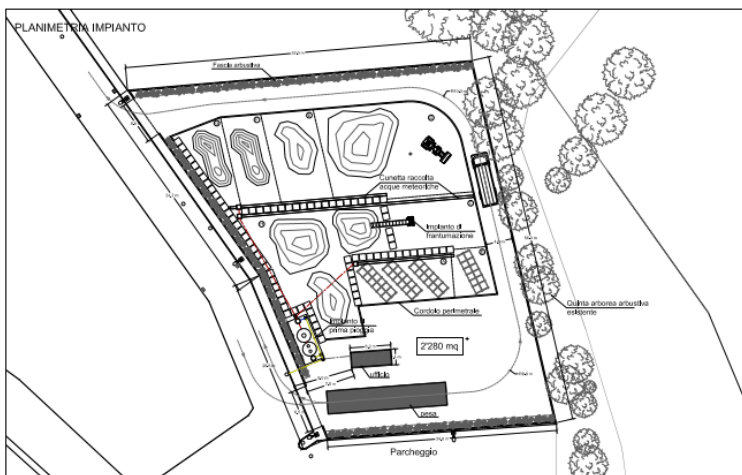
Stato di fatto e planimetria dell'impianto in progetto.
